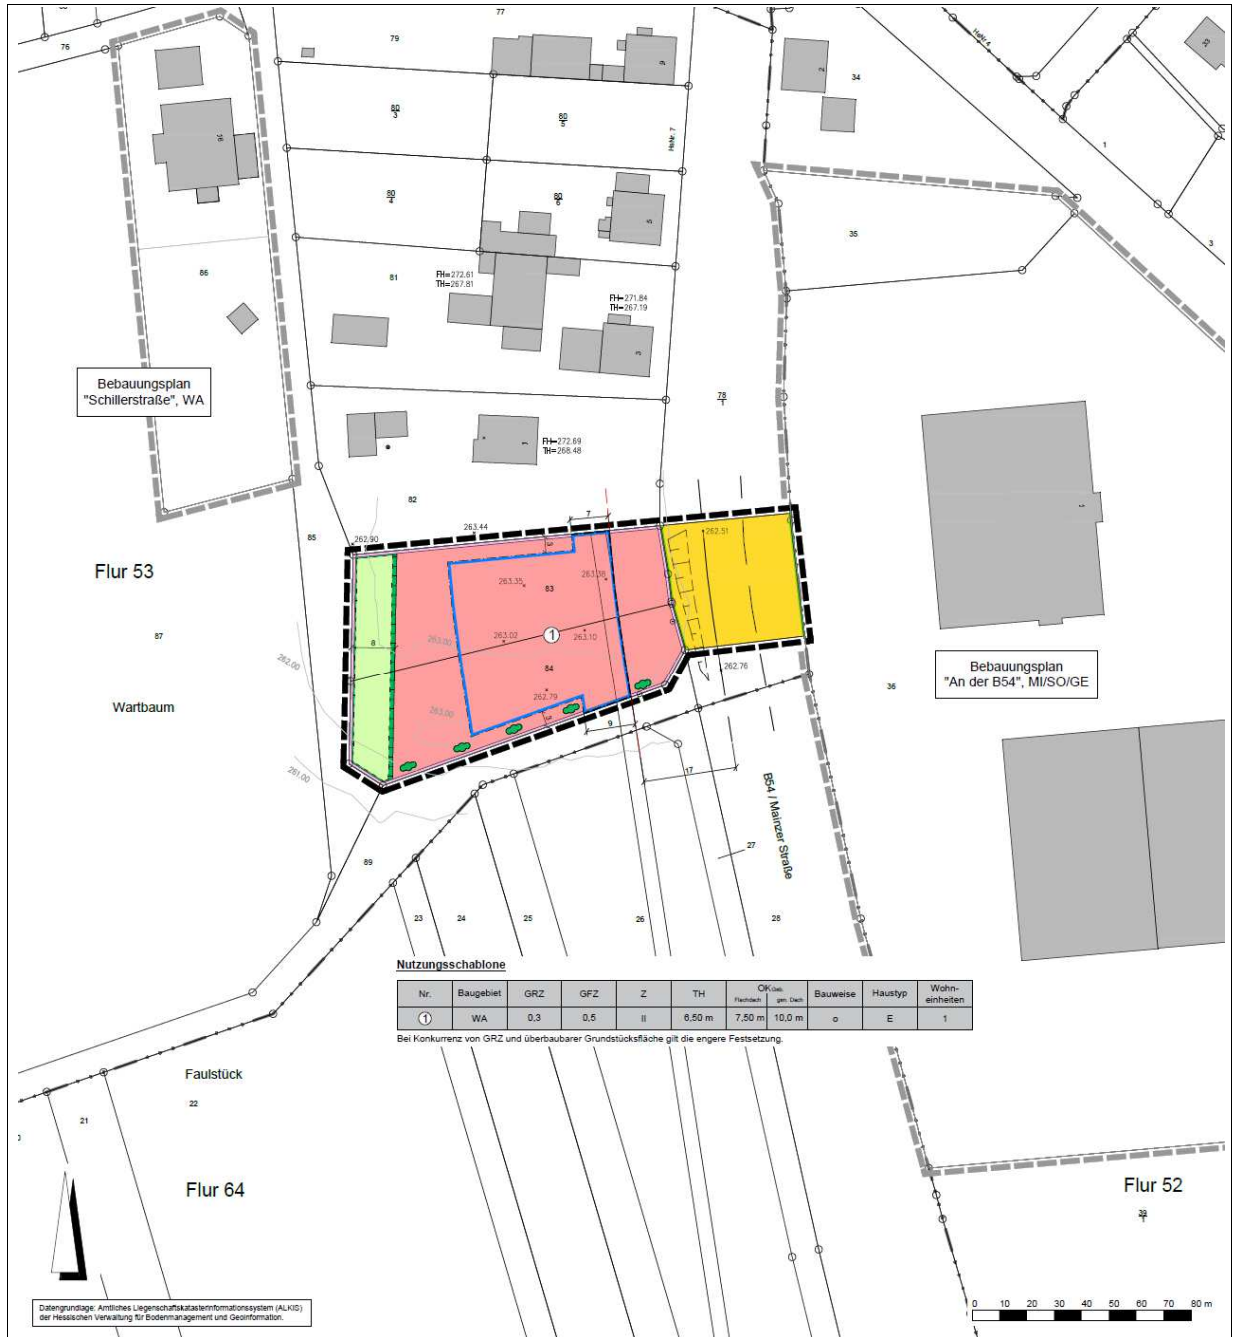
Plangebiet (Ausschnitt, Vorentwurf Planungsbüro Fischer).
